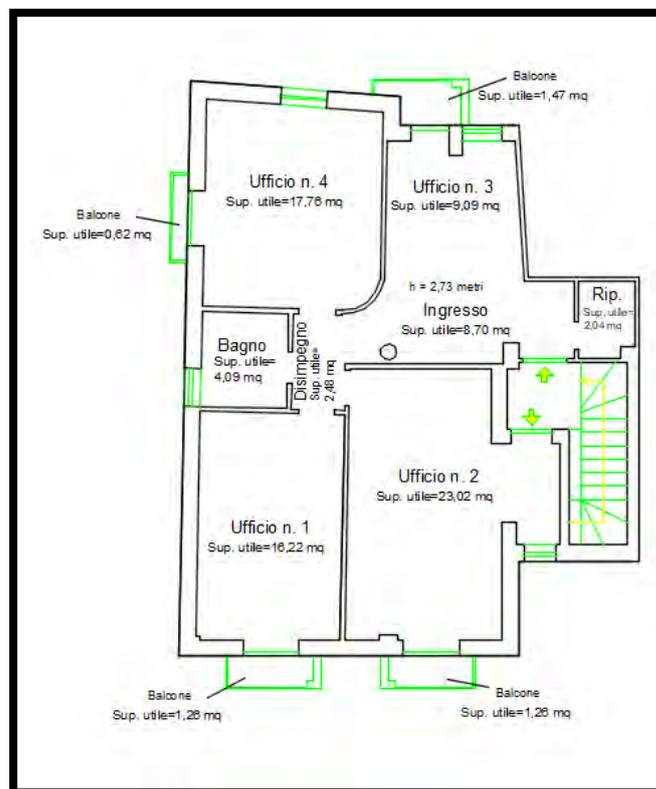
Rilievo appartamento part. 1391 sub 4 – Piano secondo
